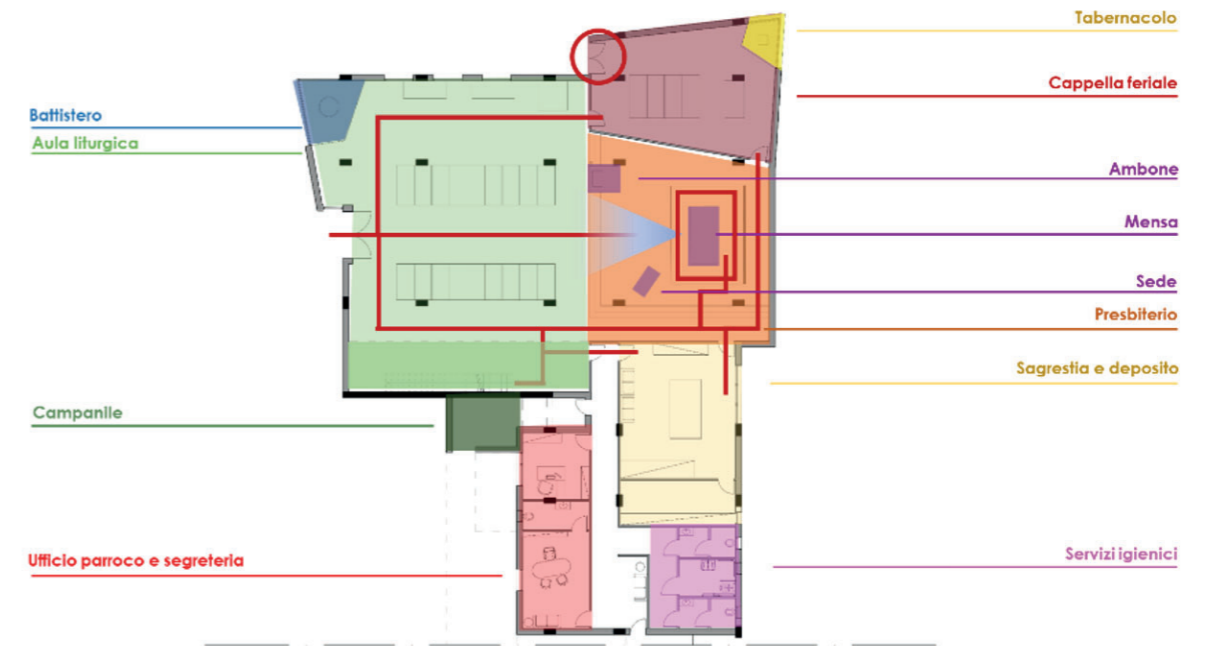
Distribuzione planimetrica interna Chiesa e uffici. Progetto gruppo "Per connettere"
